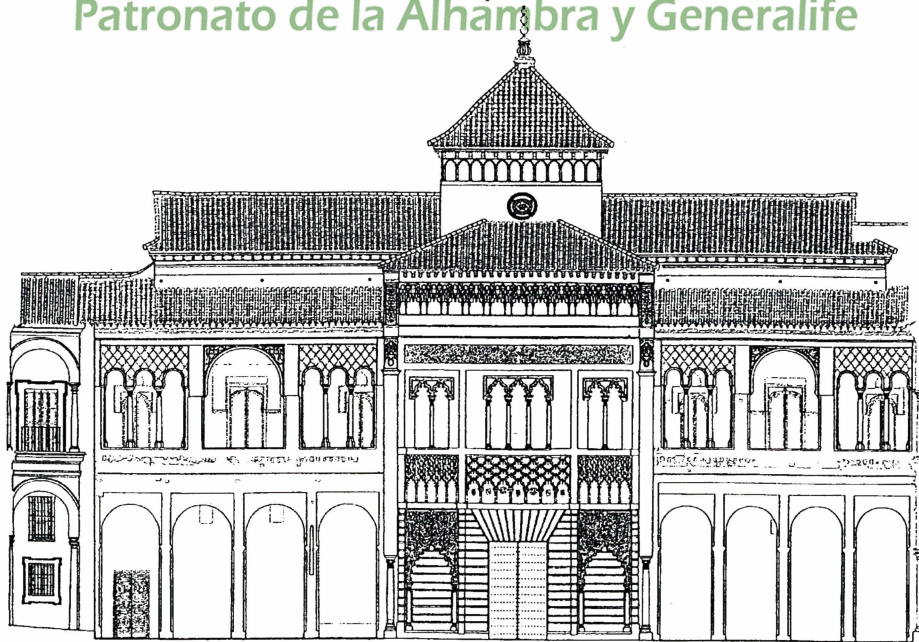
Alcázar de Sevilla. Palacio del Rey D. Pedro. Fachada norte o de la Montería (1364),
